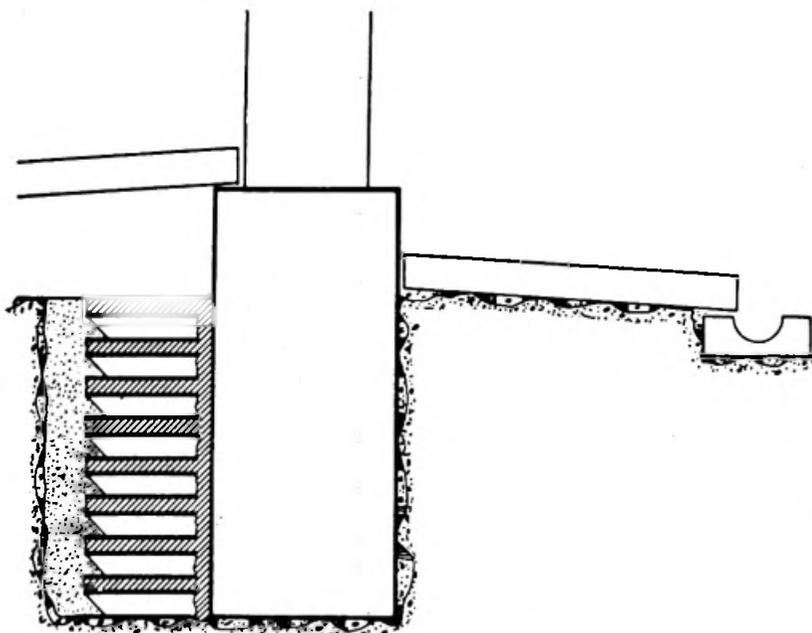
Tratamento fundação para combater movimentos horizontais..
